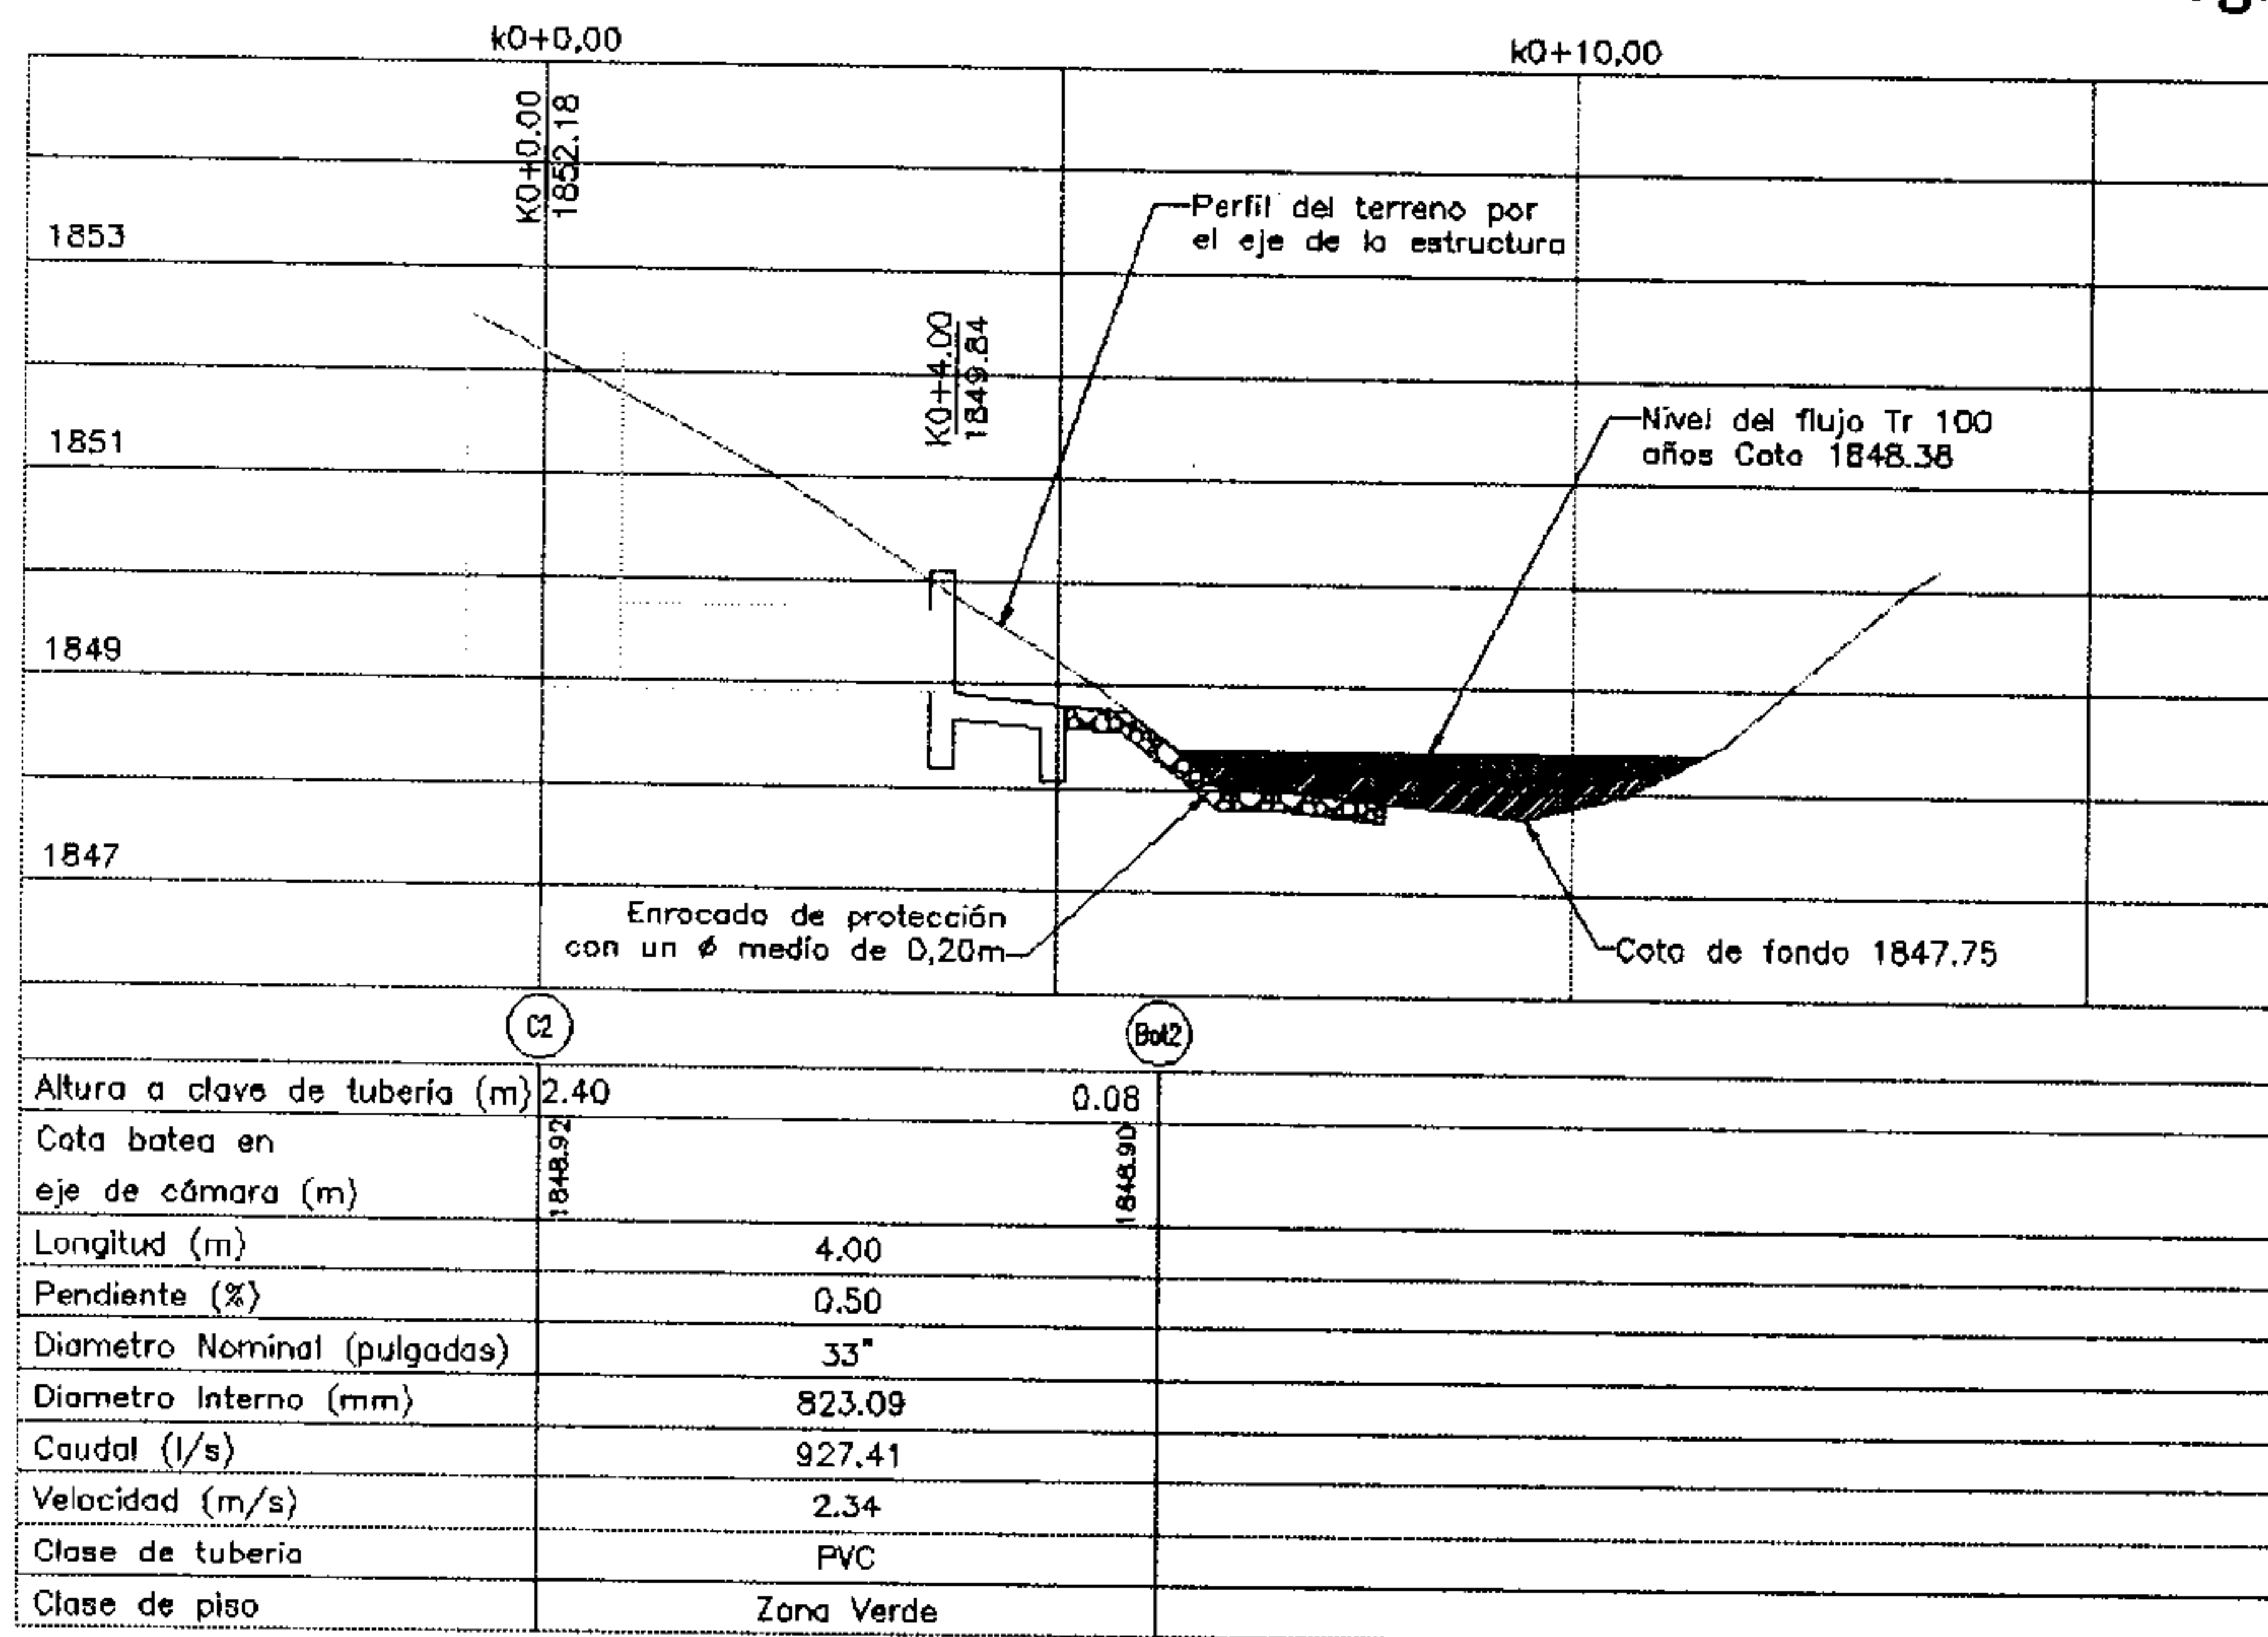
Detalle de la descarga de aguas lluvia B2 propuesta.
